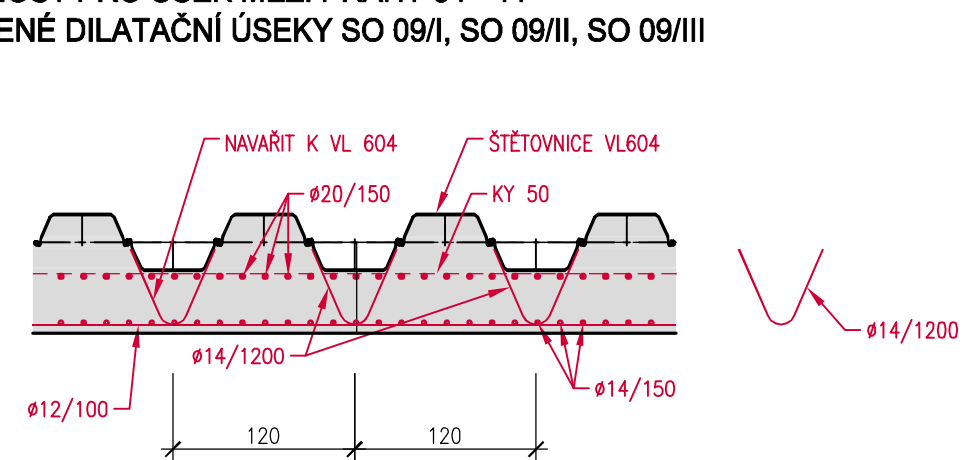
DETAIL SPŘAŽENÍ ŠTĚTOVNICE VL 604 - PŮDORYS
